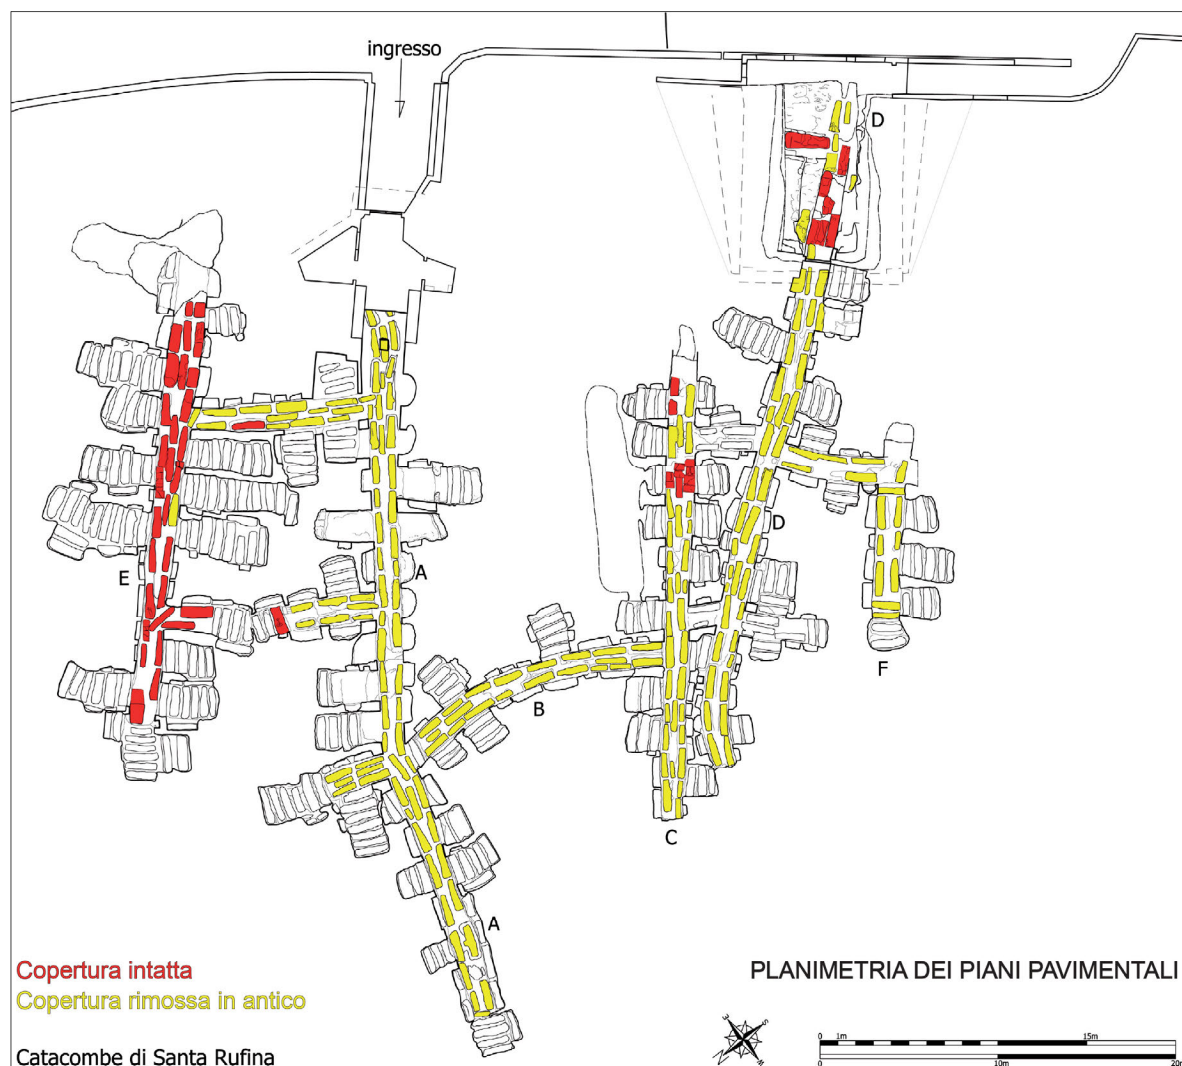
Schema con l'identificazione delle sepolture dei pavimenti.
